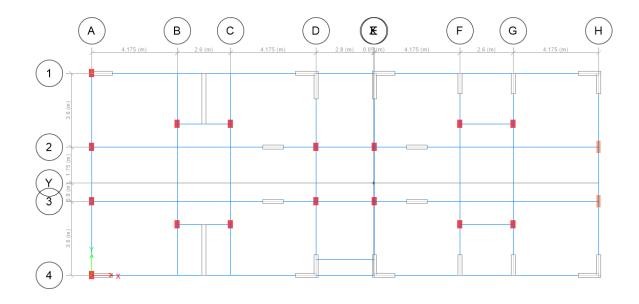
Planta de Estructuración modelado en el software ETABS V16.2.1
